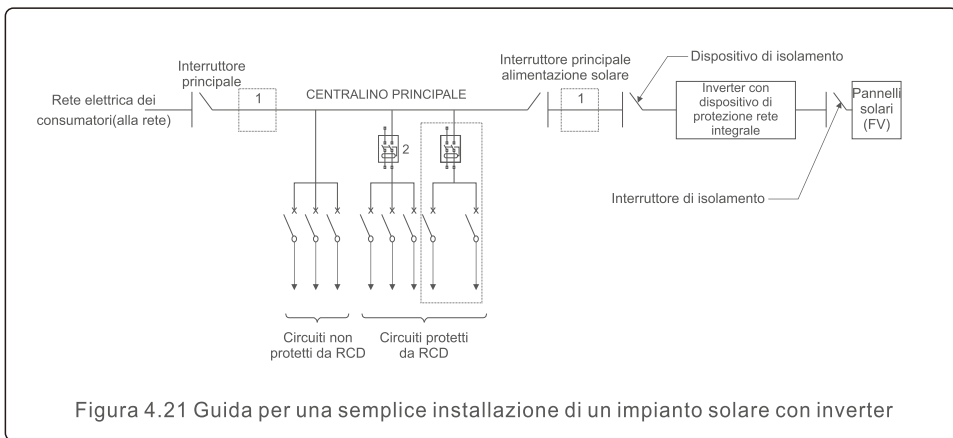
Guida per una semplice installazione di un impianto solare con inverter
